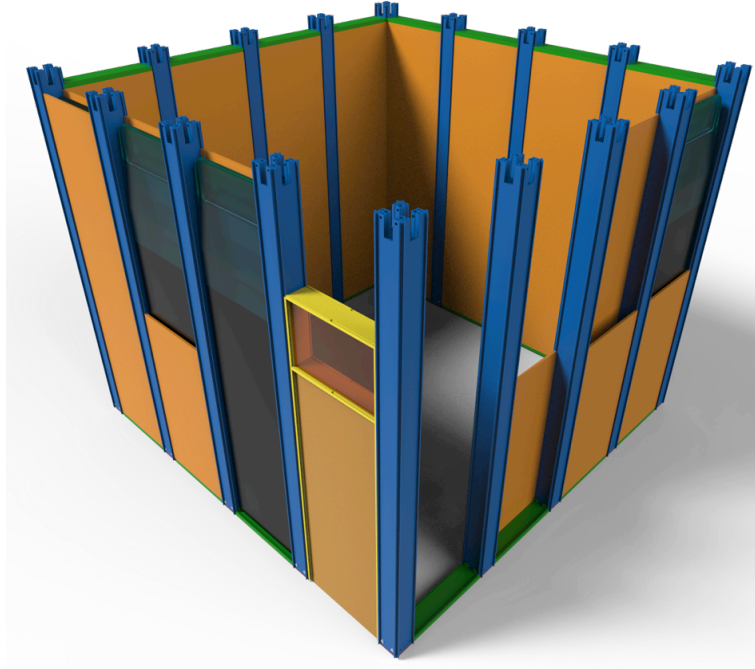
Ubicación de Cisternas Flexibles; detalle de sistema de doble pared falsa.
